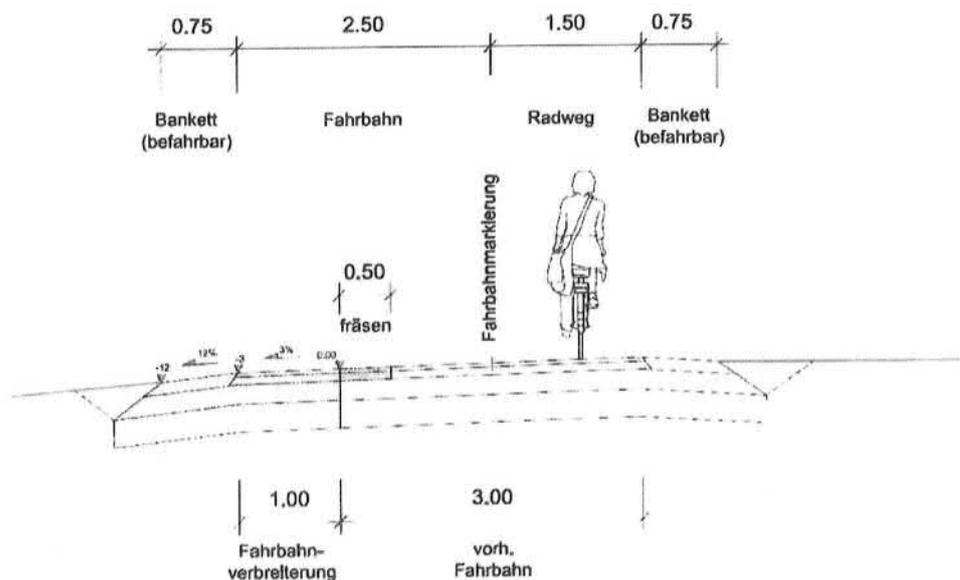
geplante Verbreiterung der Straße „An der Wassermühle“ innerhalb des Geltungsbereichs mit Markierung eines Radwegs, Baukonzept Neubrandenburg, August 2016
